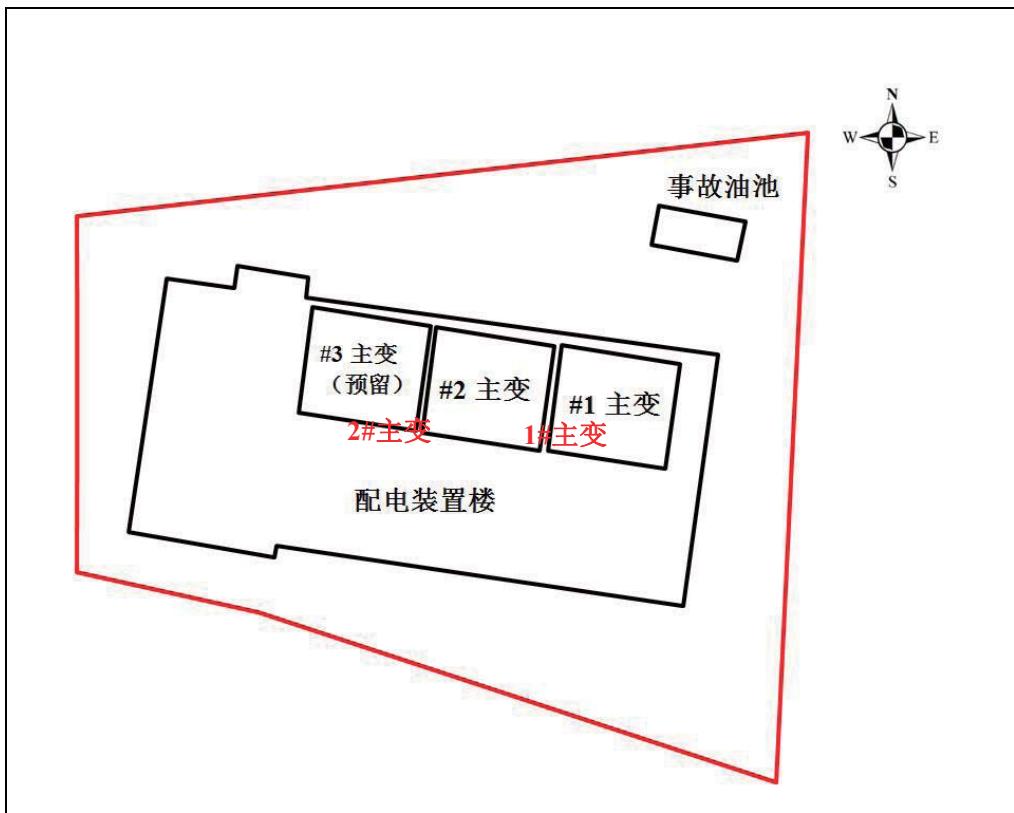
广州 110 千伏裕丰变电站总平面布置示意图
